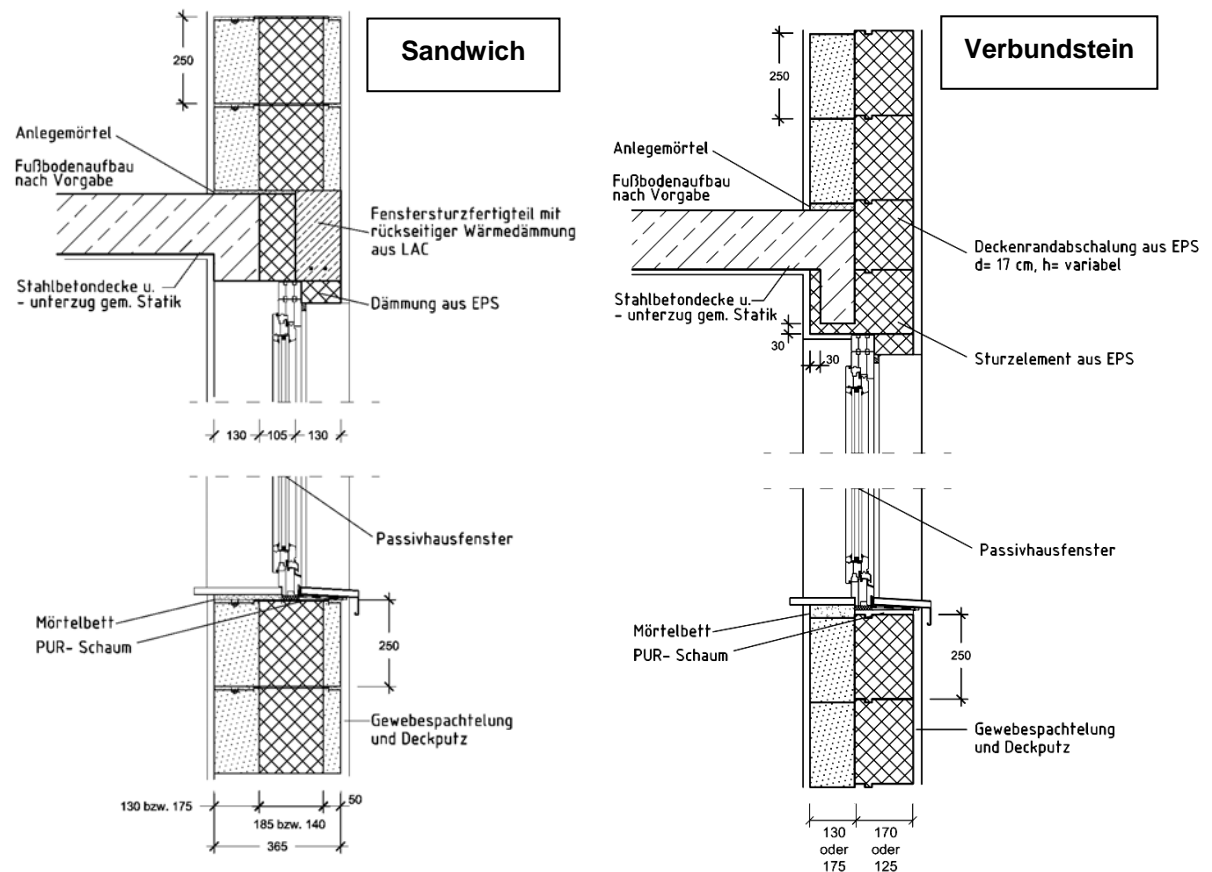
Fensteranschlussdetail und Ausbildung angeschalter Sturz in Deckenplatte nach Statik; links: Abfangung der Vorhangfassade aus LAC durch Fertigteil aus Leichtbeton mit verzinkter Bewehrung; rechts: vorgeformtes Sturzelement zur Verbundsteinvariante mit Nut und Feder in der Lagerfuge (s. Verbundkopfvariante) als verlorene Schalung
